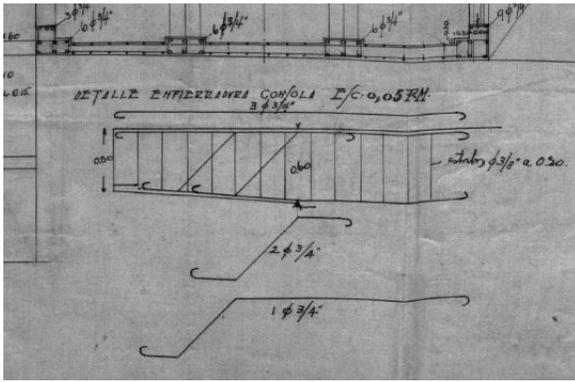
Detalle encuentro estructuras segunda y primera etapa. Fuente: Archivo DEPA MOP
